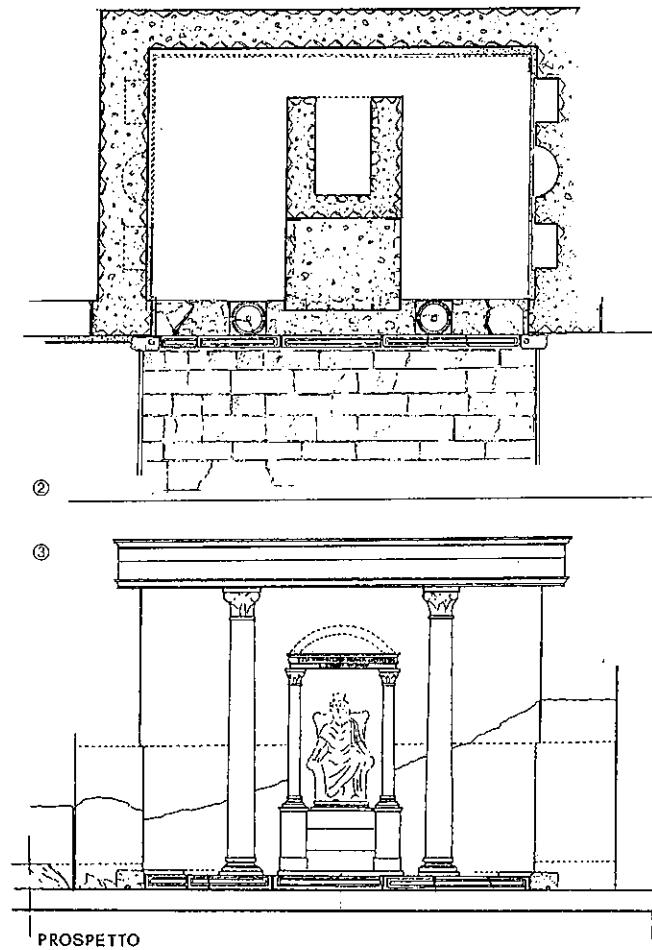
e 3. Pianta e prospetto dell'ambiente e dell'edicola di T. Statilius Optatio nel suo interno.
